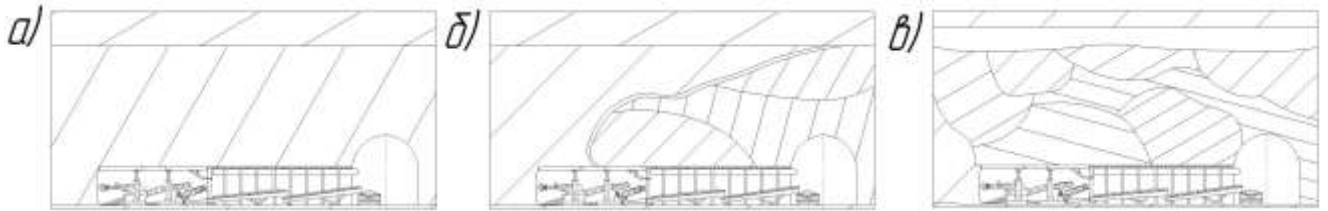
Варианты нагружения шагающей крепи: а – отсутствие внешних нагрузок на механизированную шагающую крепь (устойчивая кровля); б – нагружение задней секции крепи; в – распределенная нагрузка со стороны кровли выработки
